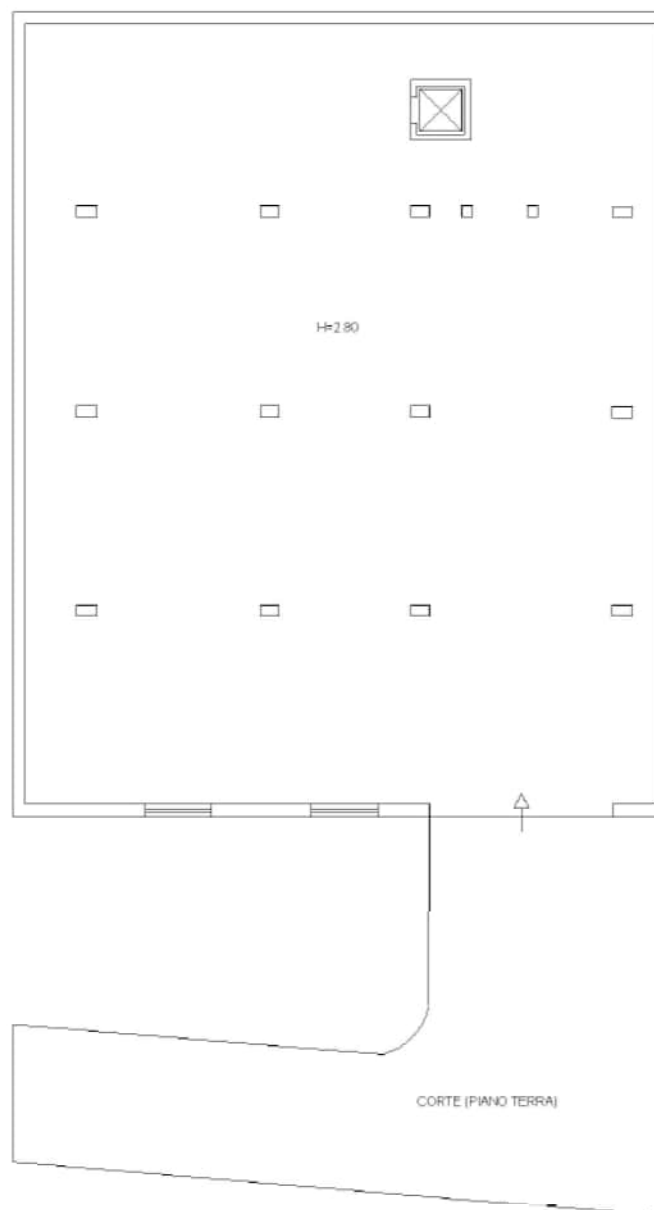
Planimetria catastale subalterno 29 – piano S2-T - particella 1016 – foglio 98 – Catanzaro
